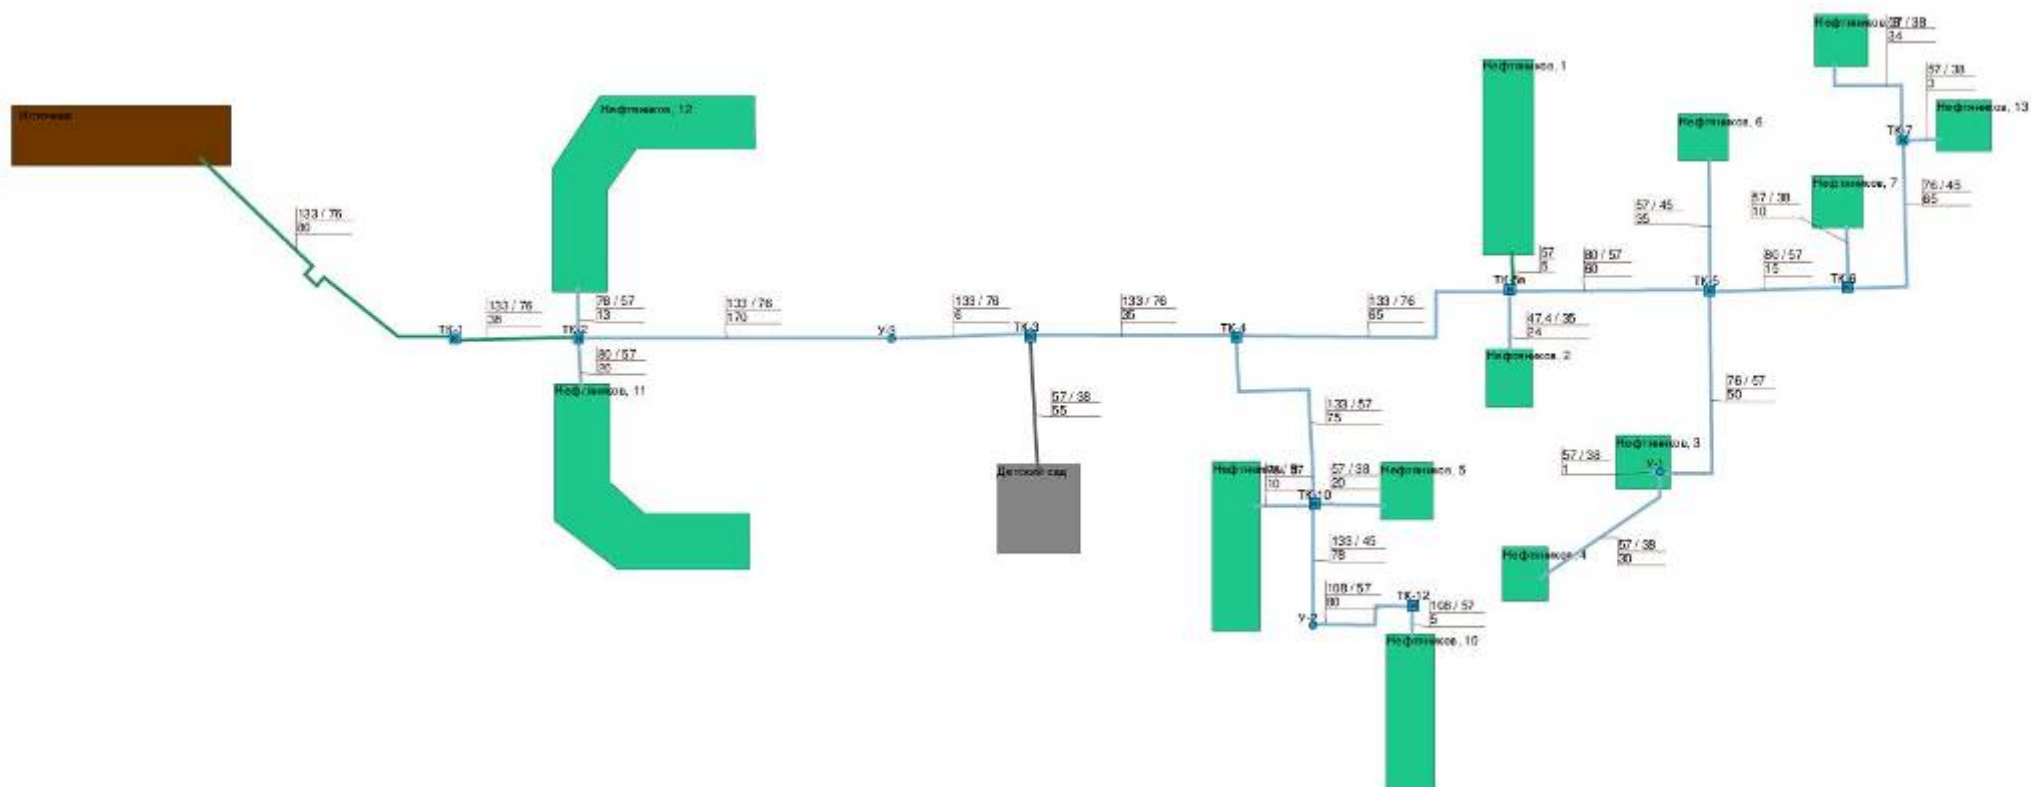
Схема теплоснабжения п. Кузнечиха нижняя (ГВС) в режиме наладки с заменой трубопроводов
